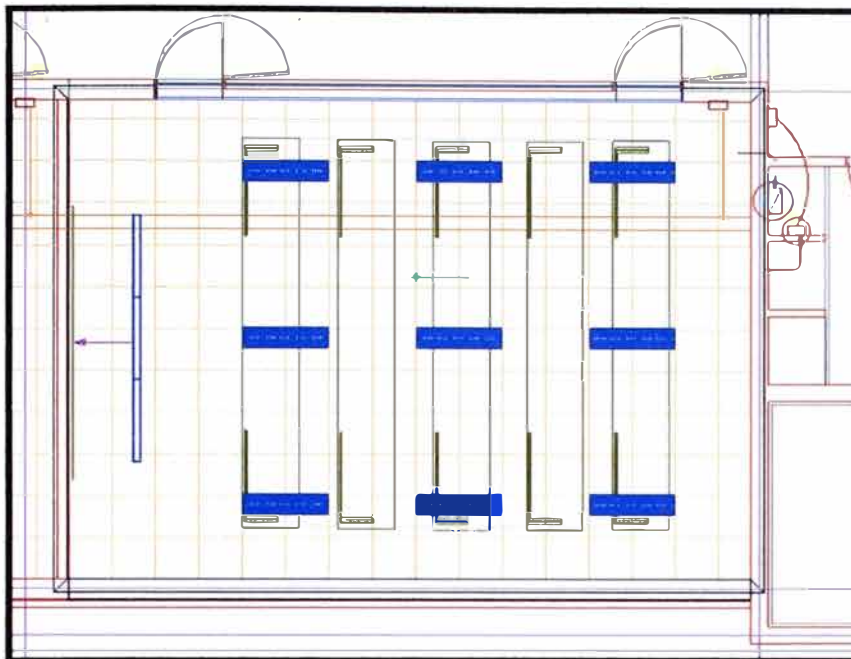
Plano del Aula B con muebles y luminarias.
